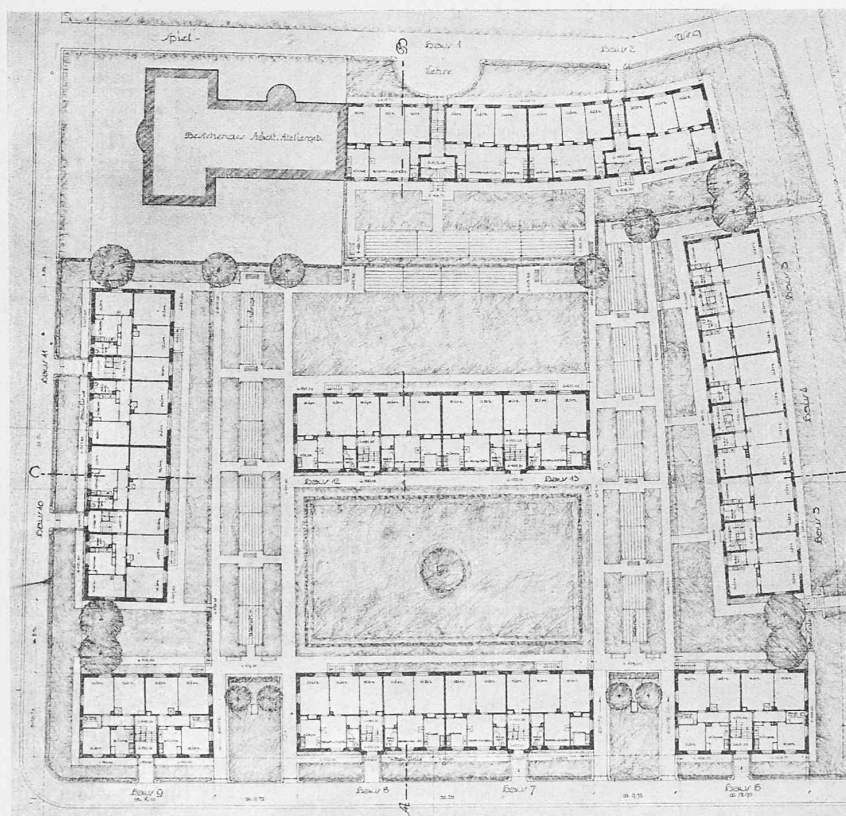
Grundrisse der Baugruppe IV. — Masstab 1 : 800.
